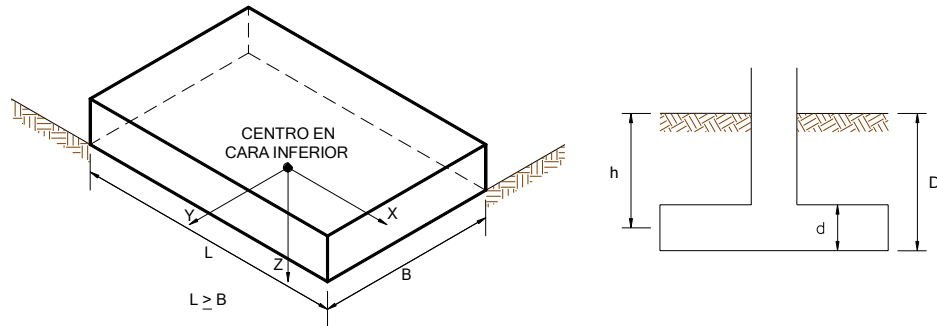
Esquemas para el cálculo de la rigidez de la cimentación.
